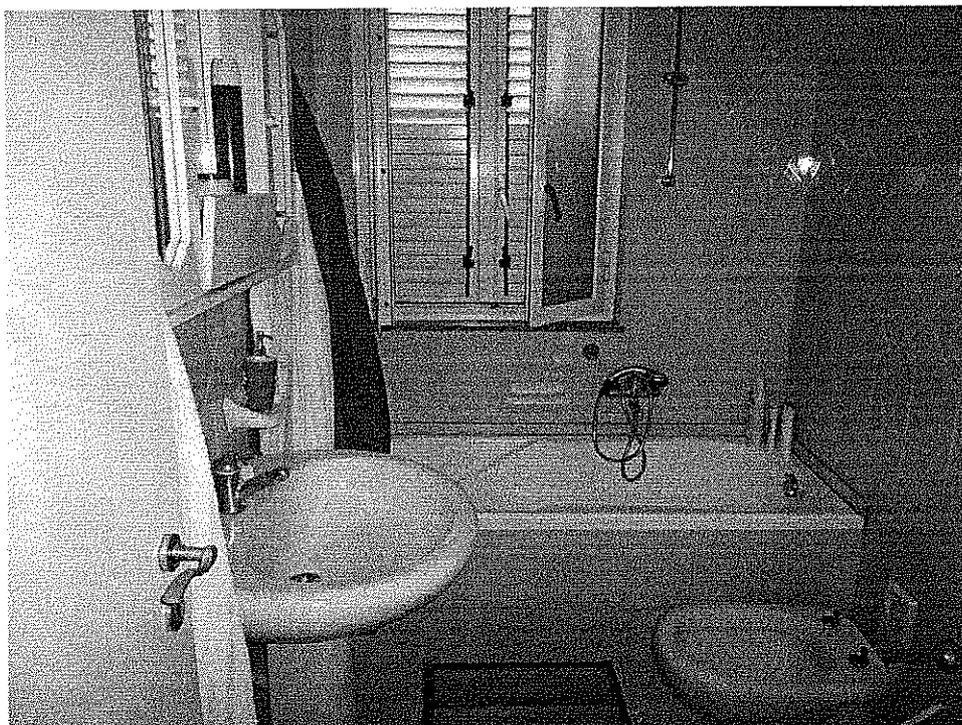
Fabbricato “1A” – Piano II – Bagno
